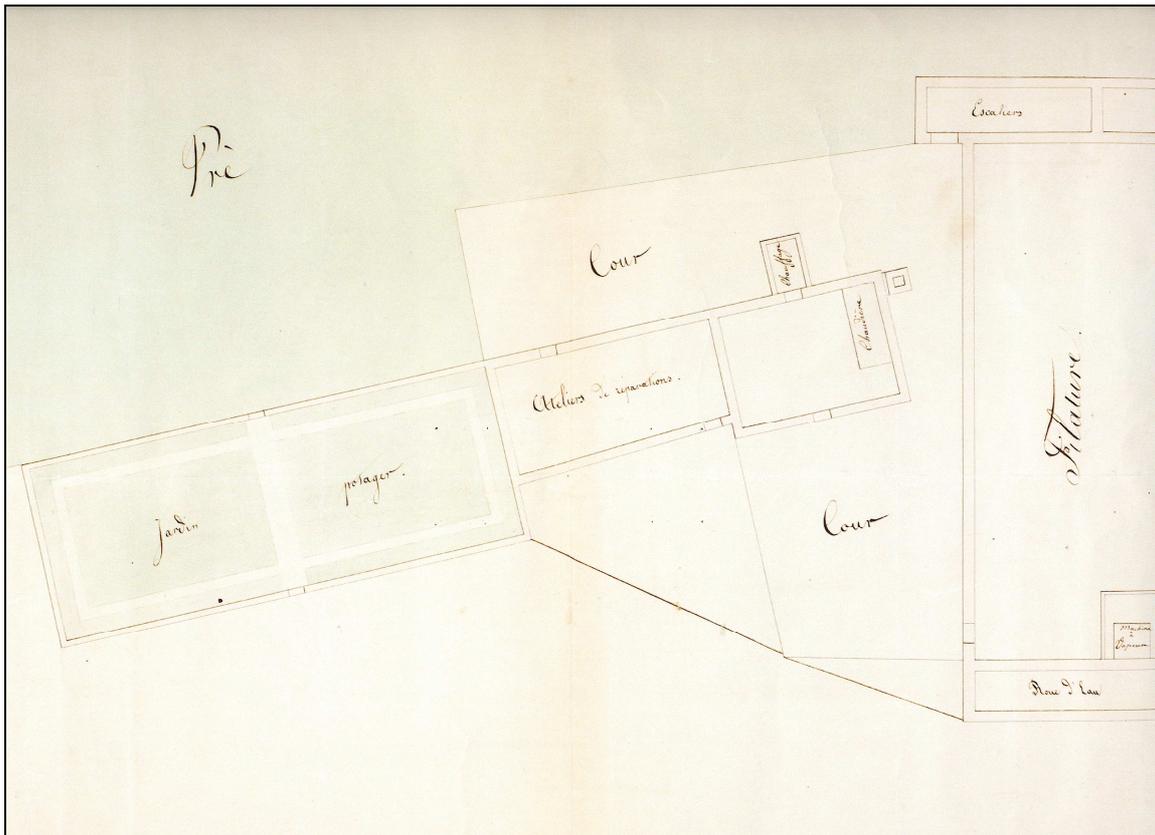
Plan de la filature Reiss en 1844 (source, ADHR 5 M 86)
